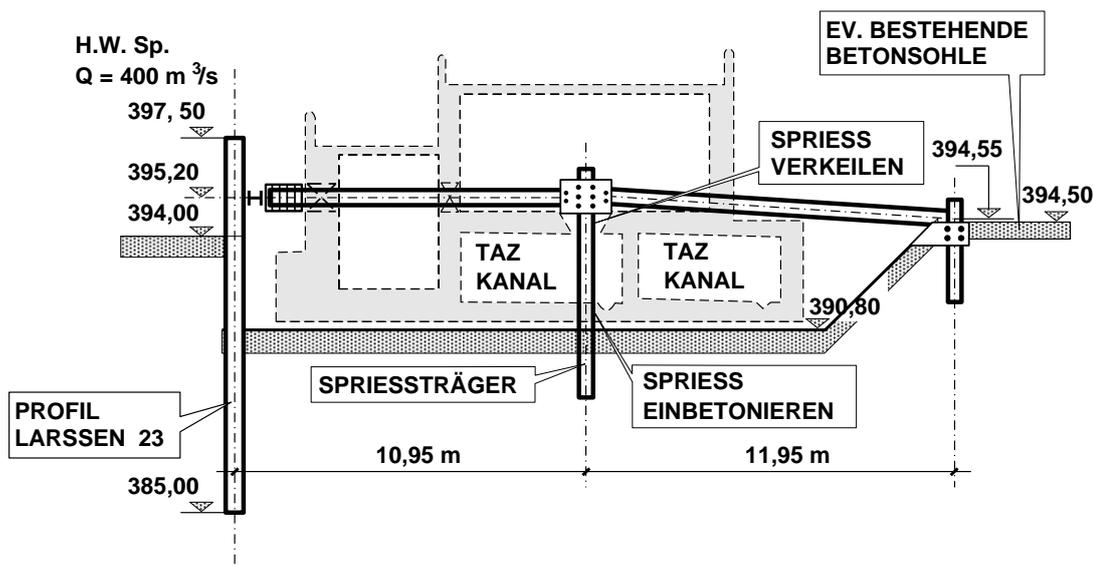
Stauwehr Hängg (Schnitt A - A)
